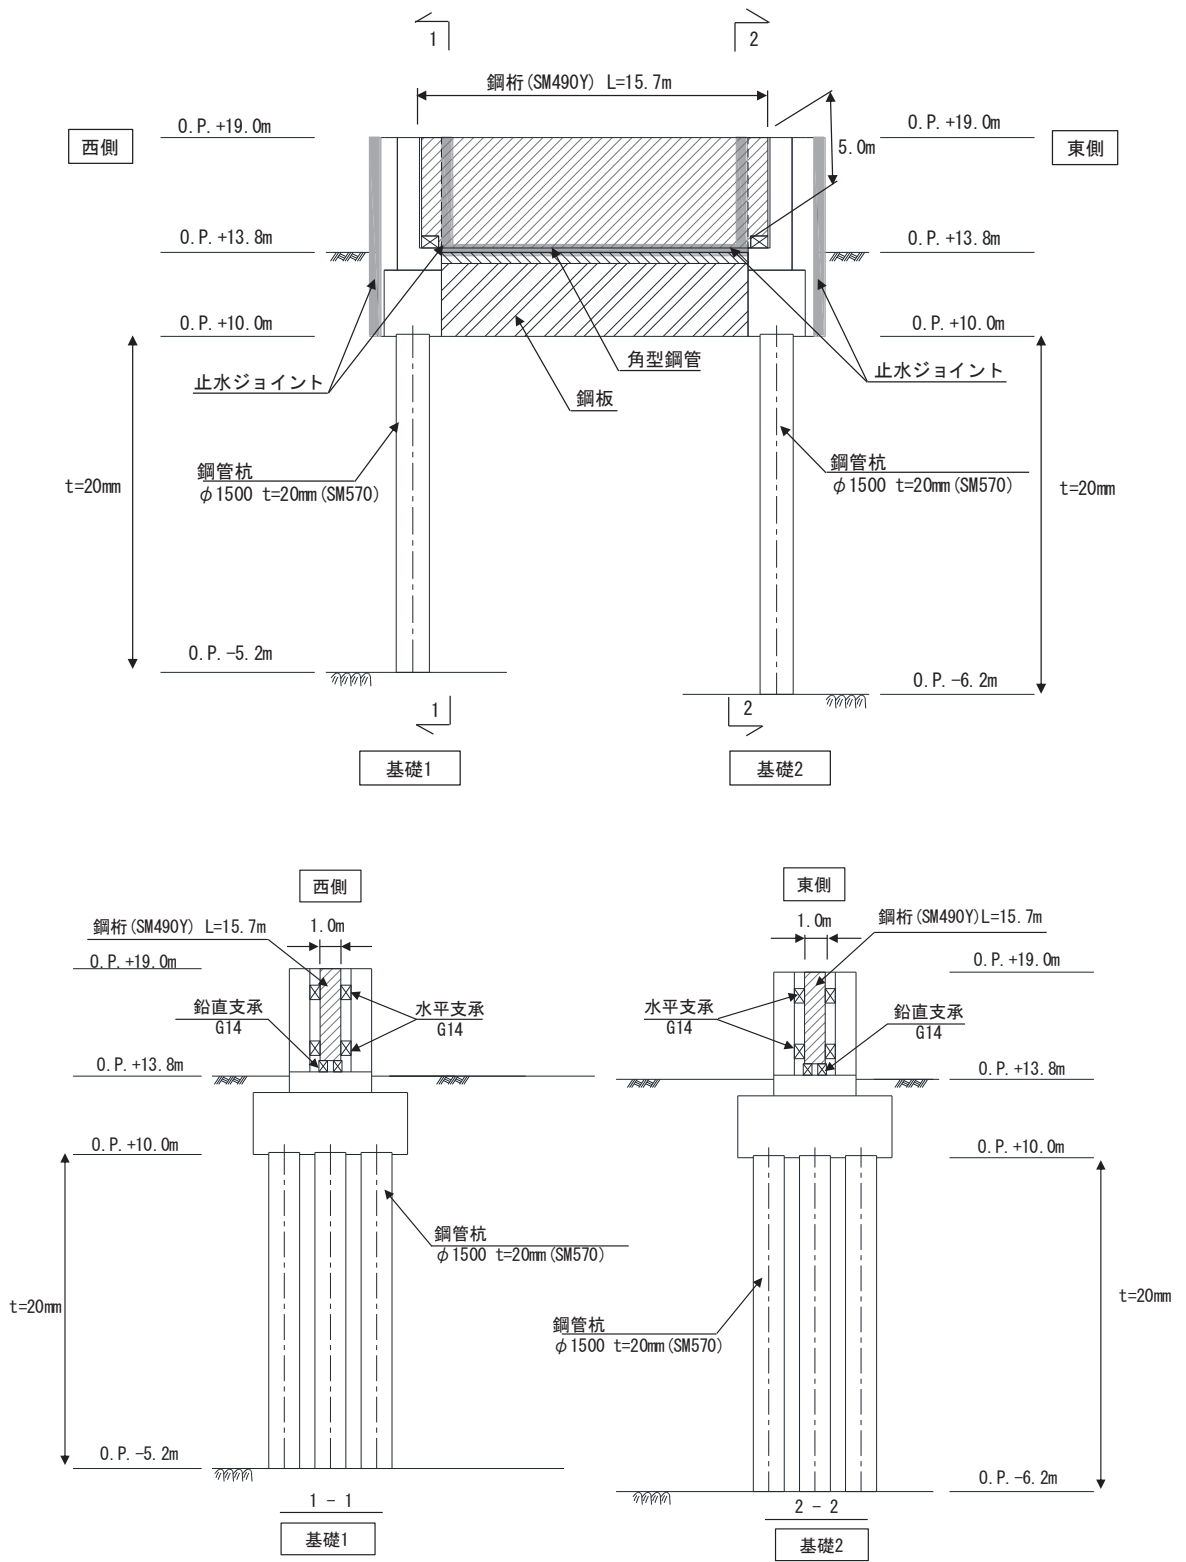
鋼製遮水壁 (鋼桁 3) 正面図及び断面図
